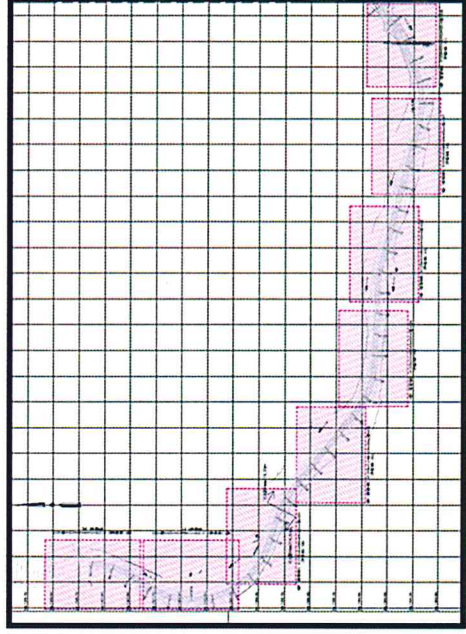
Projeto do Canal de Nova Avanhandava – Versão 100% de escavação submersa
